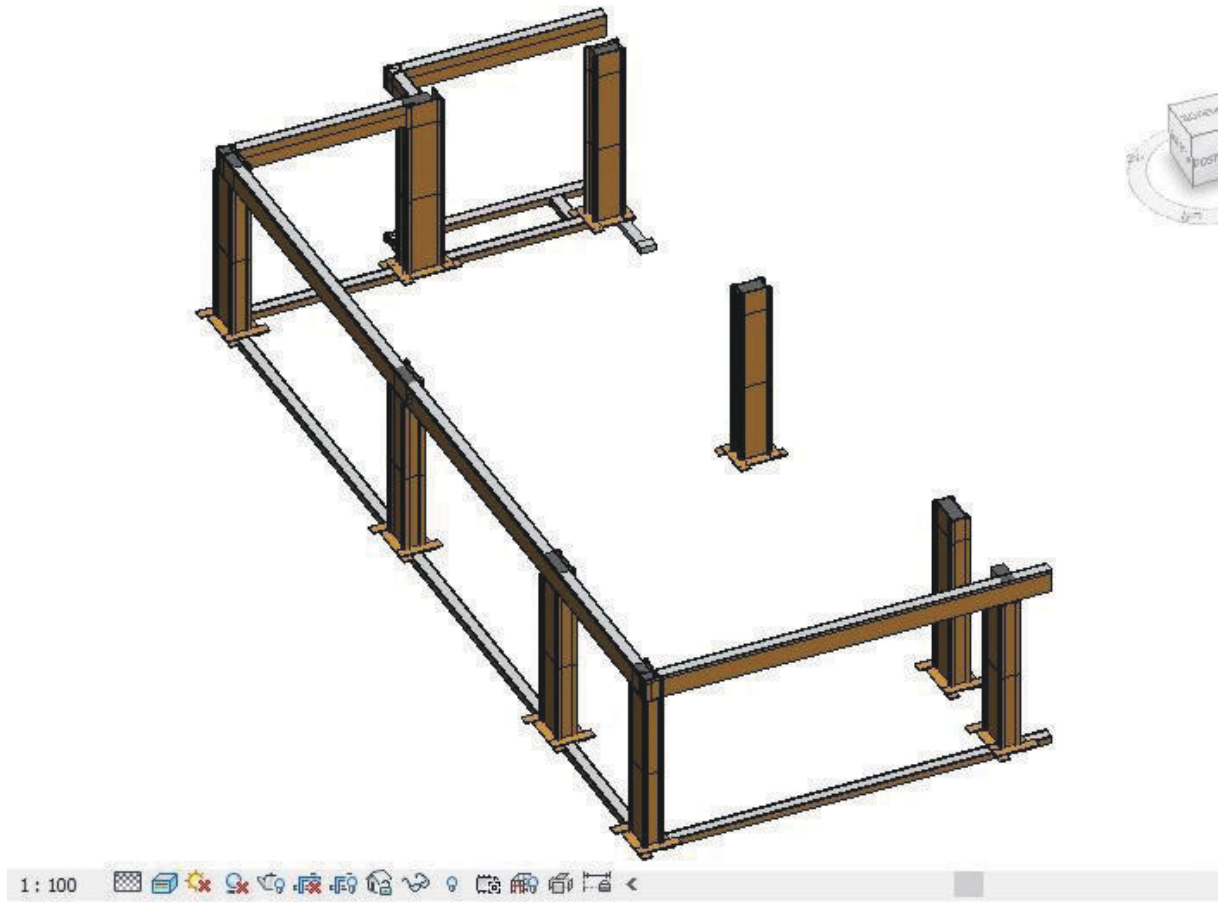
UTILIZAÇÃO DA PRACHA DE EXECUÇÃO EM OBRA
